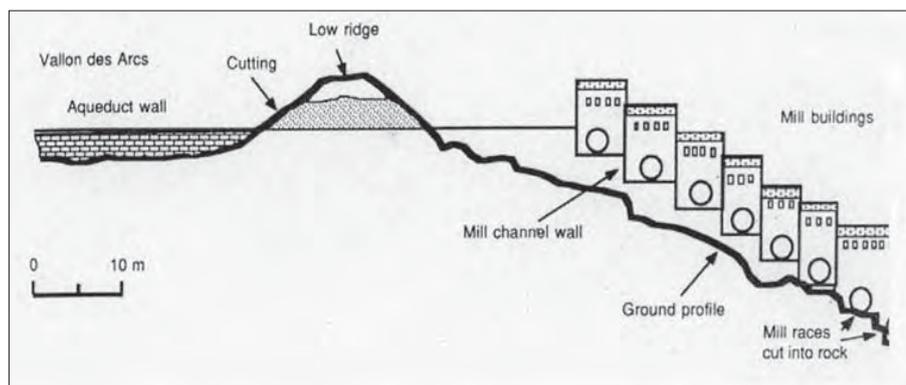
Sezione dell'impianto (Viollet, 2000)
